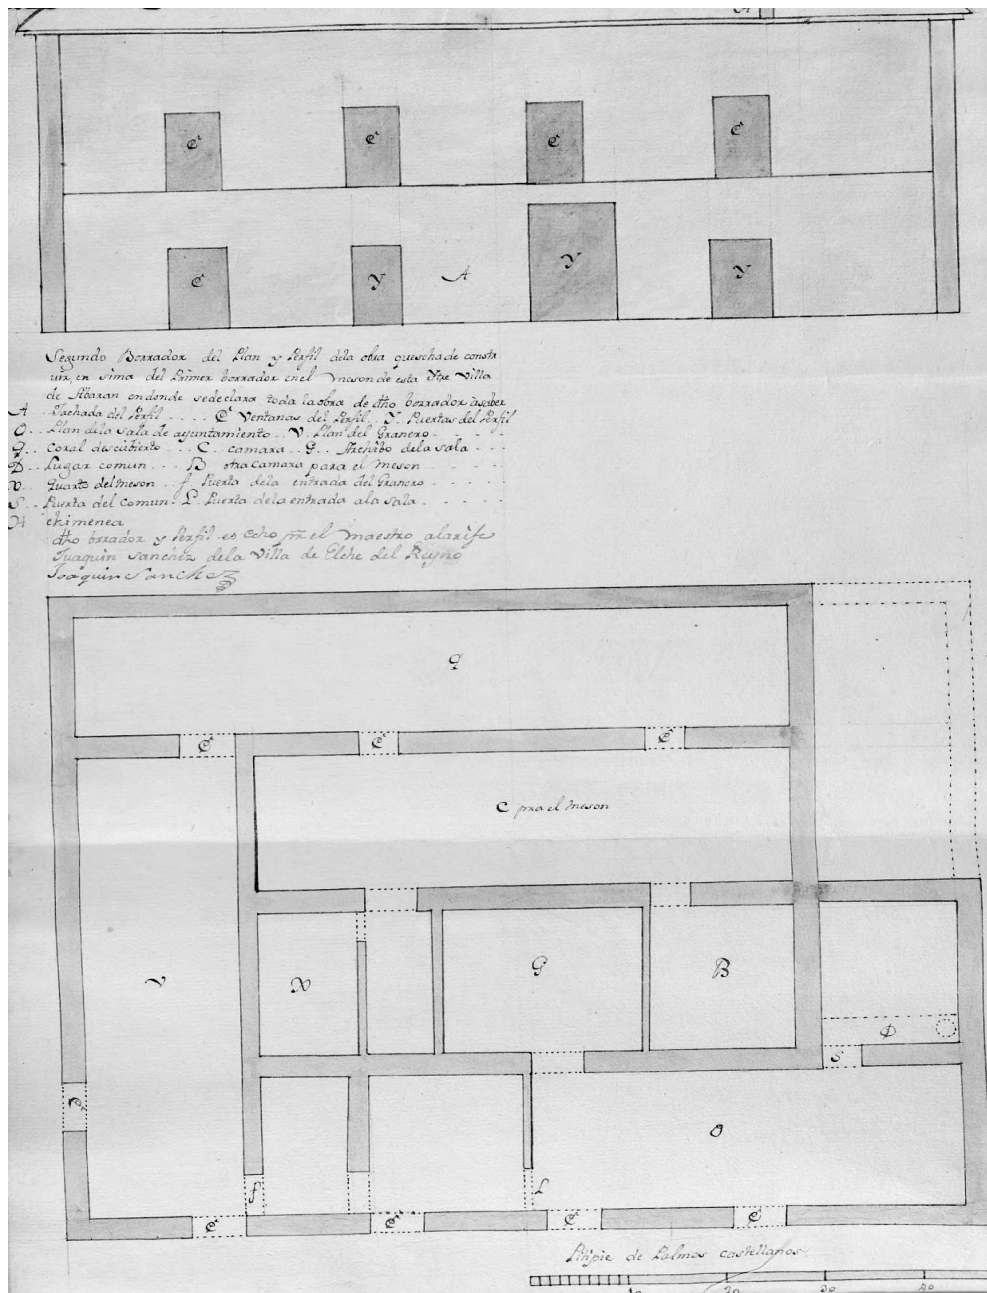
Plano y perfil de la casa consistorial de Abarán. 1784. Representación de la segunda planta y perfil de la fachada.
